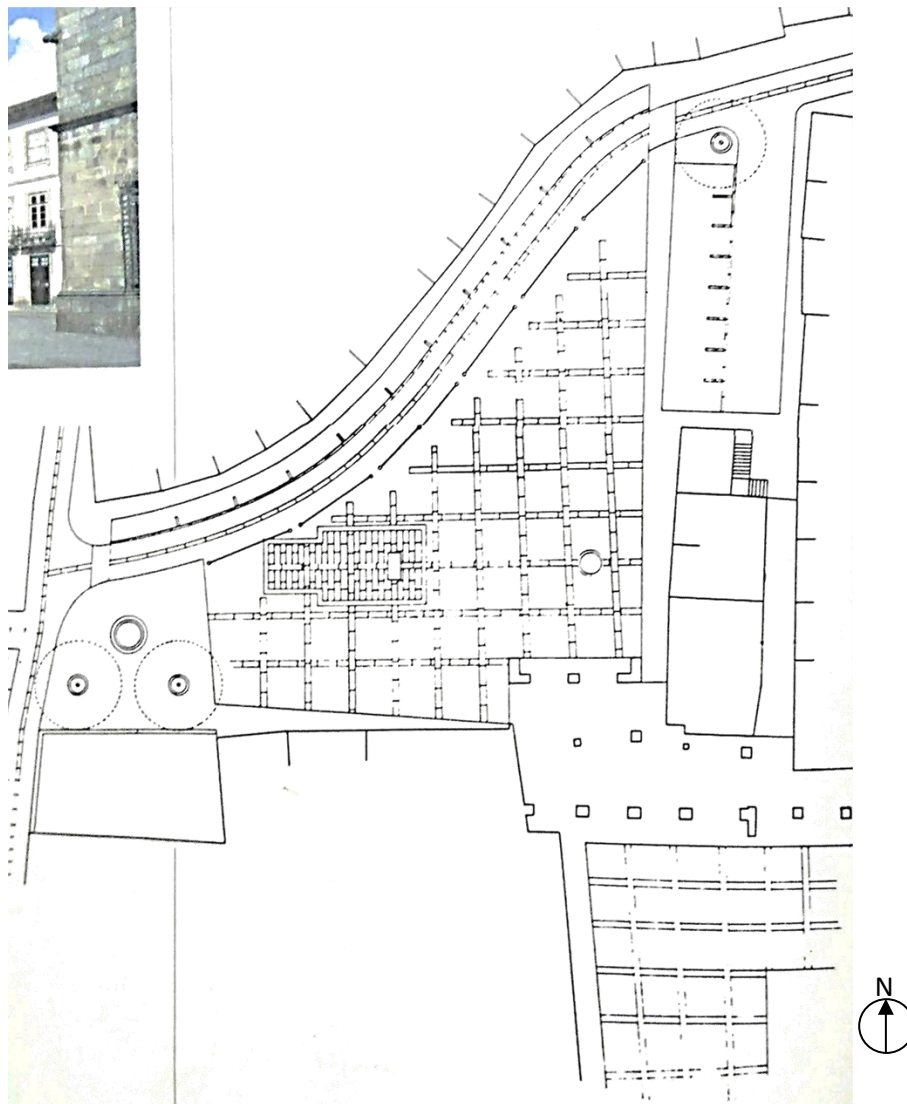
Planta da praça de Santiago. Fonte: (Trigueiros, 1993), (sem escala).
